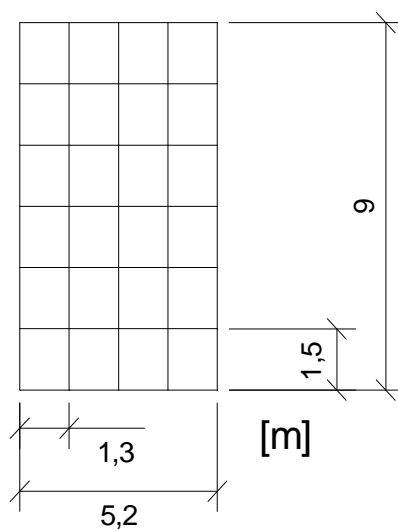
Vista da Configuração Do Plano Longitudinal do Cimbra ao Solo Contínuo Adoptada Para Uma Secção Tipo de Um Viaduto com 20 m de Vão e Com Uma Altura ao Solo de 9 m
